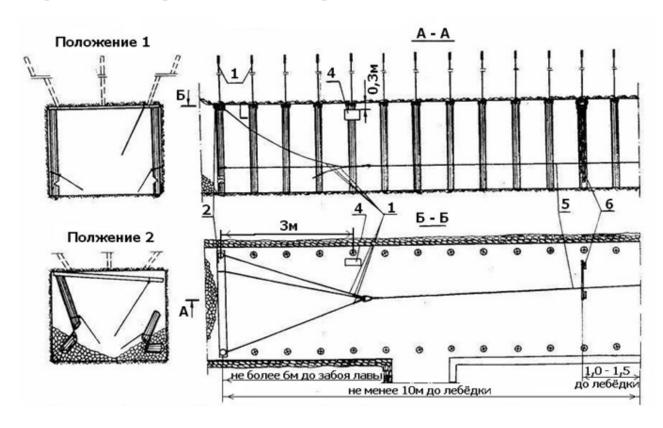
Поэлементное извлечение анкерной крепи Условные обозначения: 1 — анкера; 2 — подхват; 3 — отрезки каната; 4 — прибор непрерывного автоматического контроля содержания метана; 5 — канат лебедки; 6 — предохранительный щит
